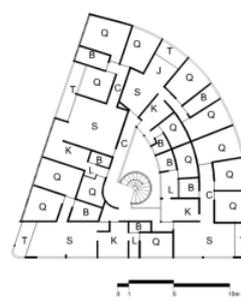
Planta Baixa 1º Pavimento. Fonte: Croqui da autora.
